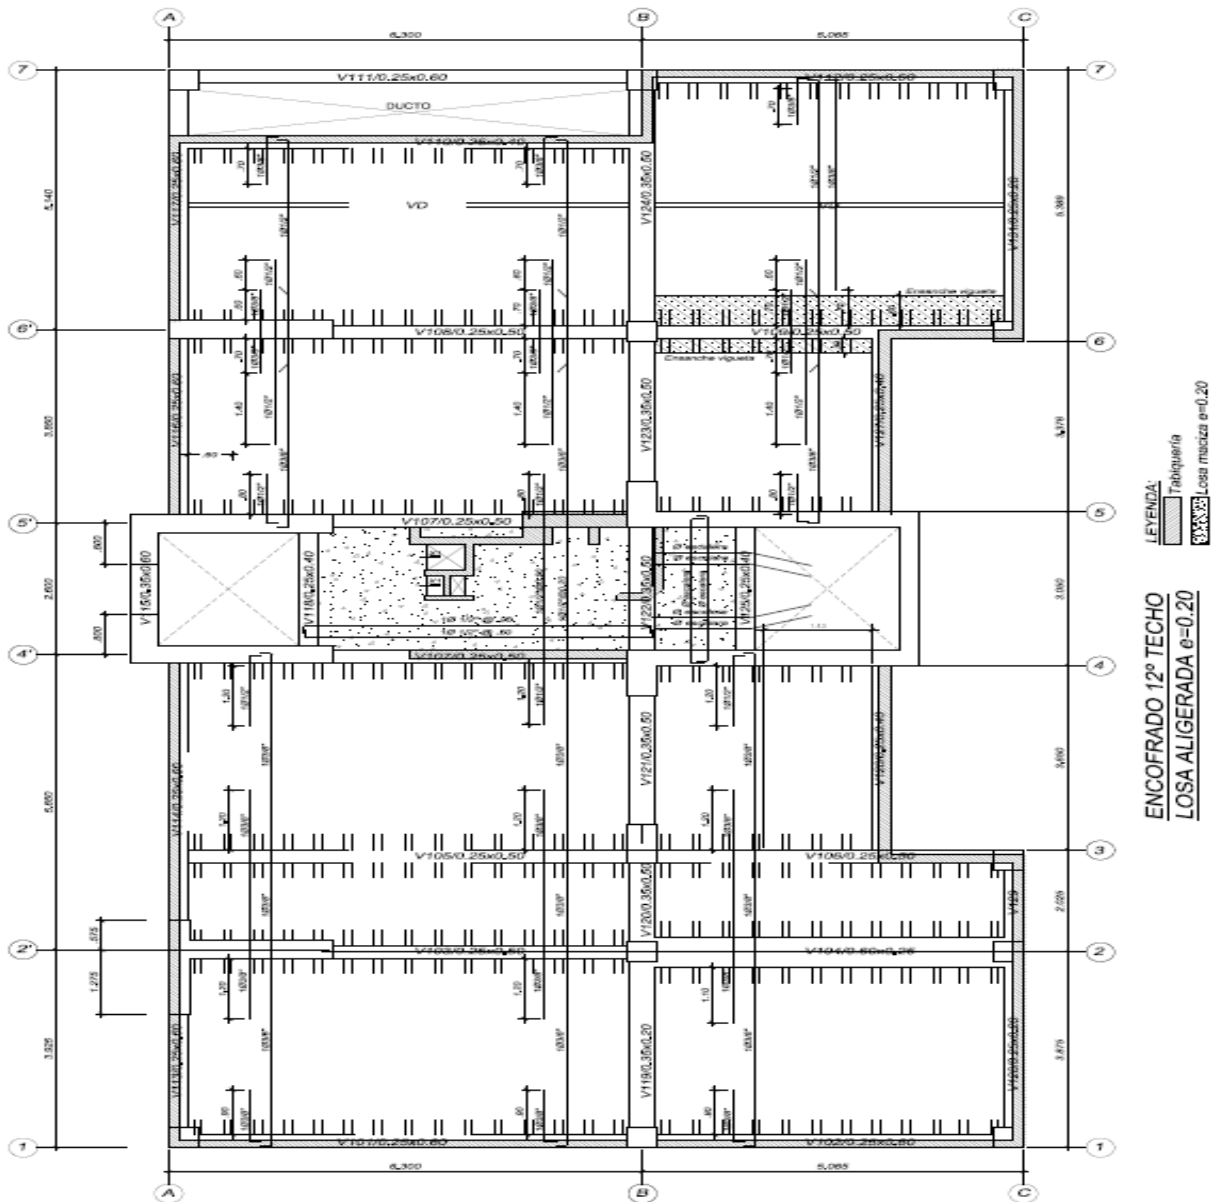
Detalle del refuerzo dispuesto en la losa aligerada Icr
